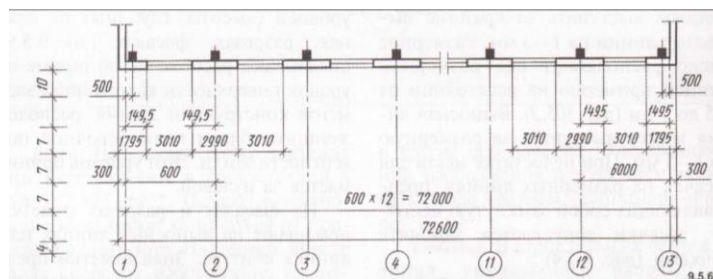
Простановка размеров стен и оконных проемов на плане здания
